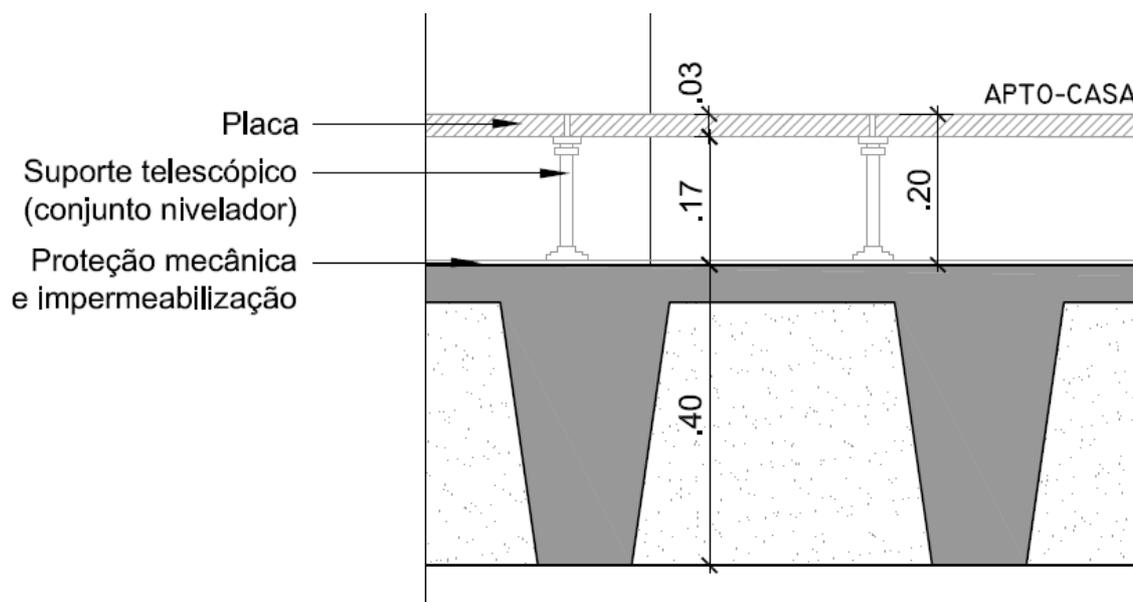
Detalhamento de piso elevado. Fonte: Elaborado pelo autor.
